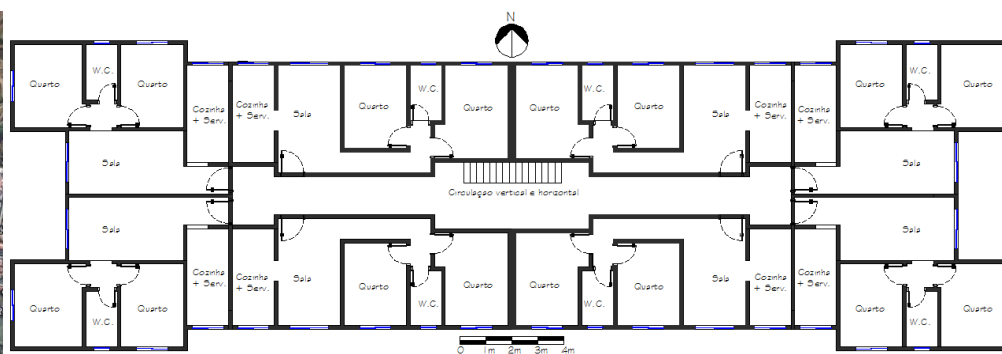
Planta Baixa do pavimento tipo do estudo de caso 2
